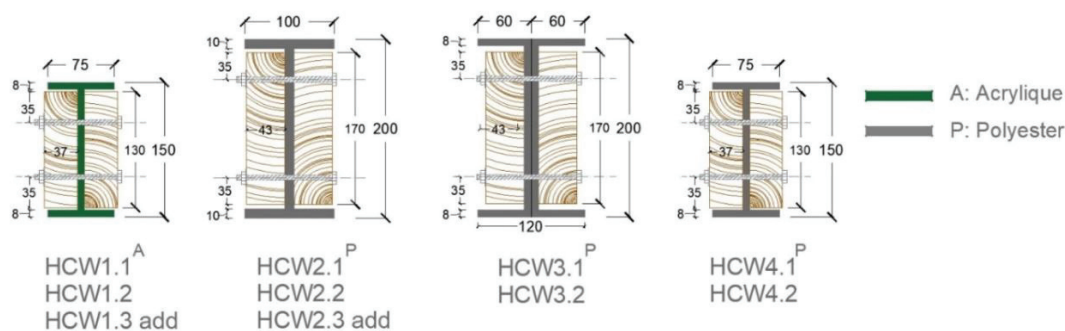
section des poutres hybrides testées en flexion et en torsion
